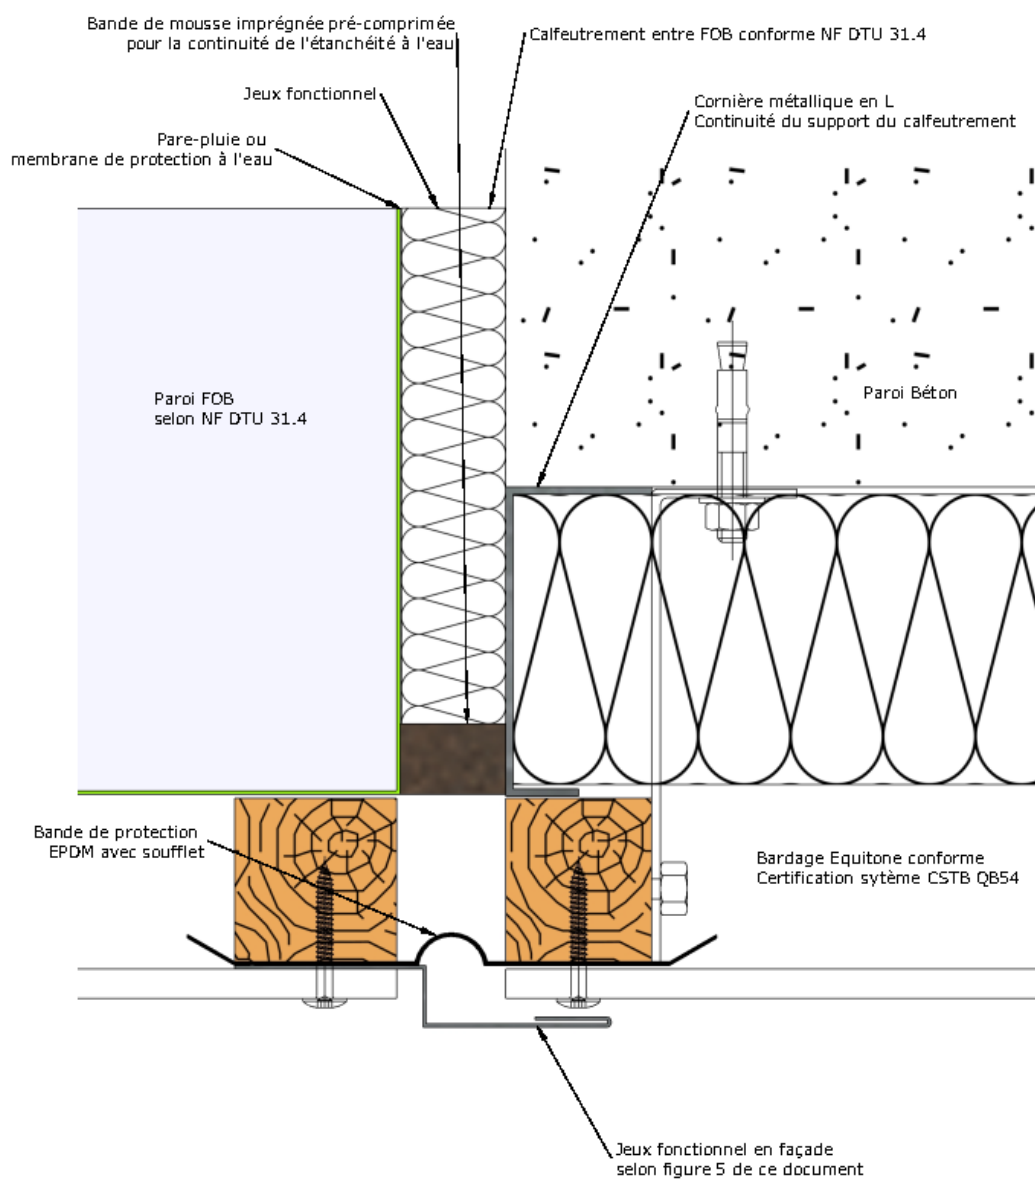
Jeu fonctionnel vertical entre une FOB et un voile béton, coupe horizontale
